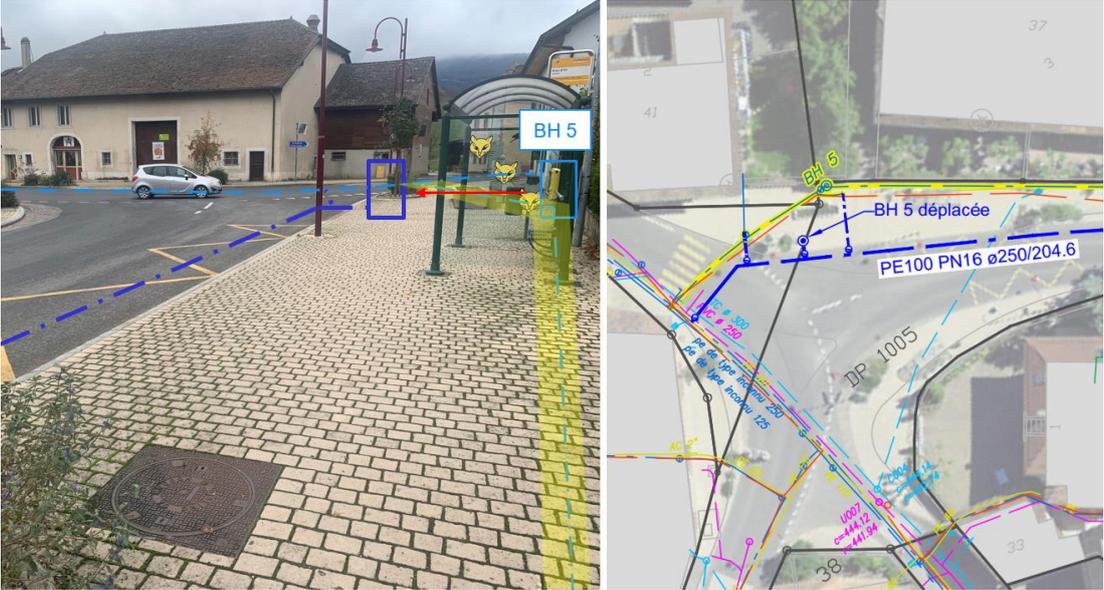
Point de raccordement ouest sur la conduite existante et déplacement de la BH 5
